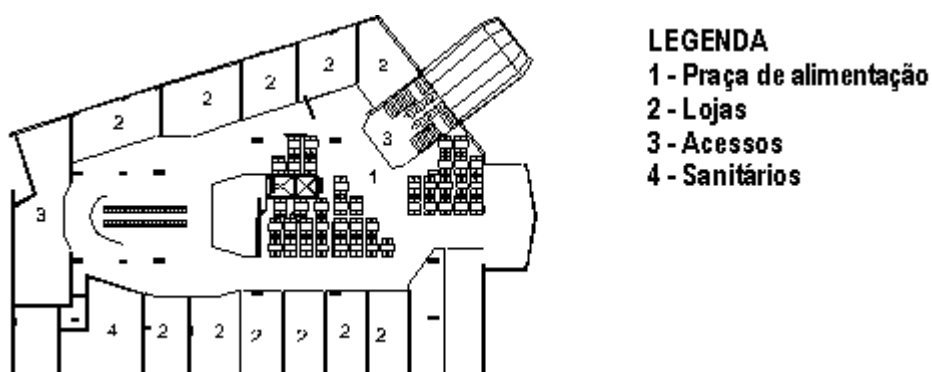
Planta baixa da praça de alimentação em edifício comercial e mini-shopping.
